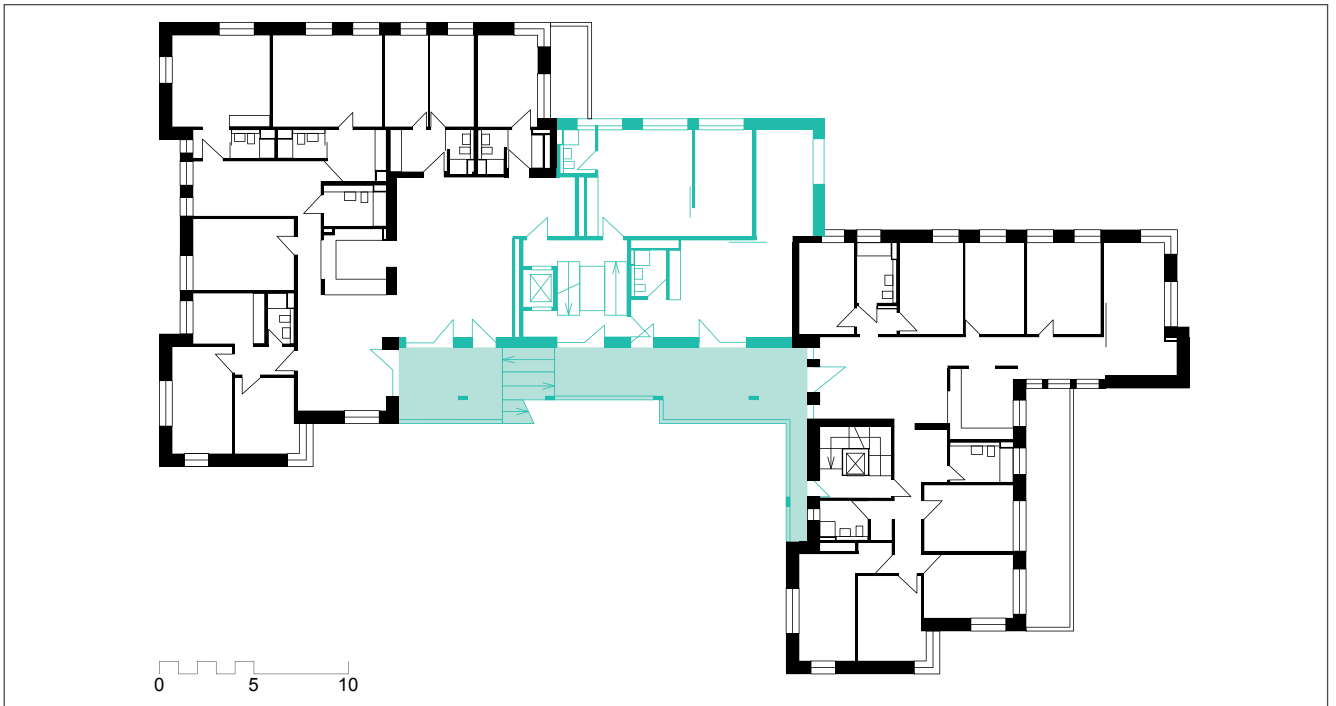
Grundriss des 2.OG mit Ausweisung des Bestands (schwarz) und des Ergänzungsbaus mit der Terrasse Commune (grün) © Adrian Streich Architekten, Zürich, Bearbeitung subsolar
